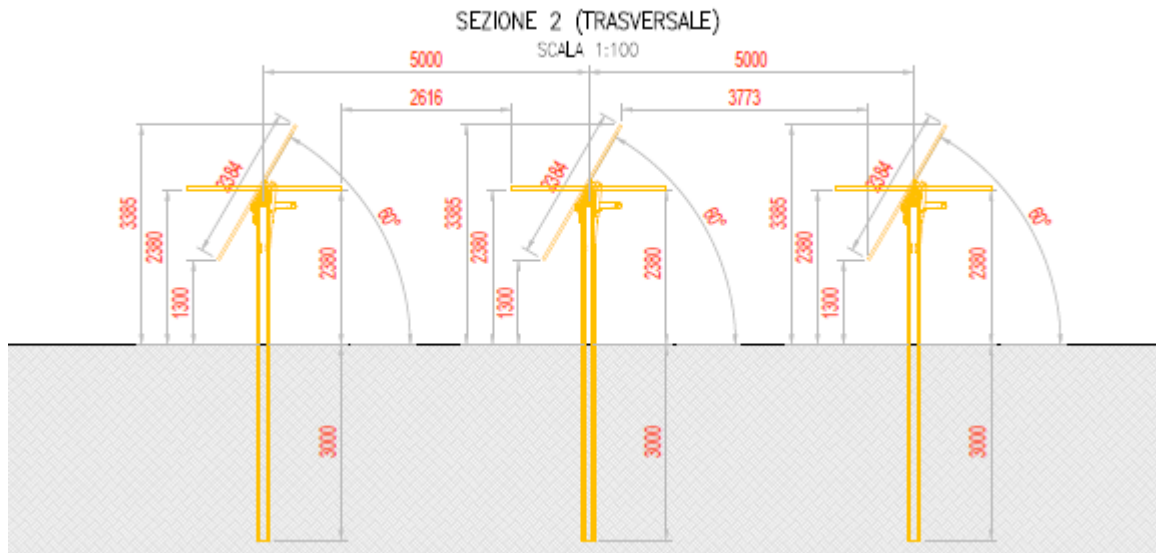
Particolare costruttivo strutture mobili (tracker)
